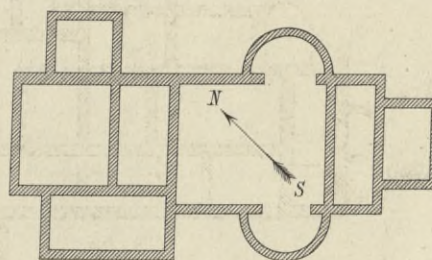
Villa beim Castell Holzhausen. 1:500.
